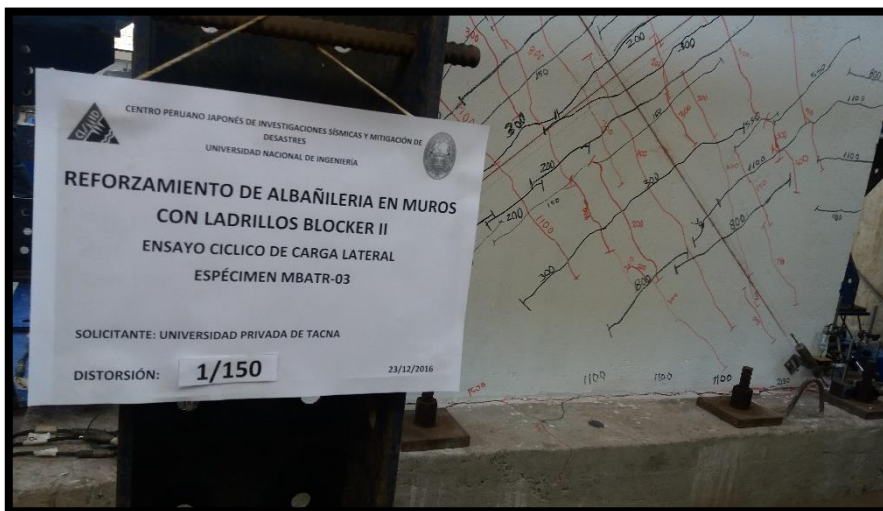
Por último el muro se pinta de blanco para facilitar el mapeo de grietas
